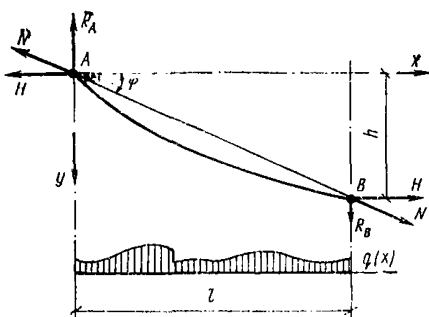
Расчетная схема предварительно-напряженной струны, нагруженной произвольной вертикальной нагрузкой
